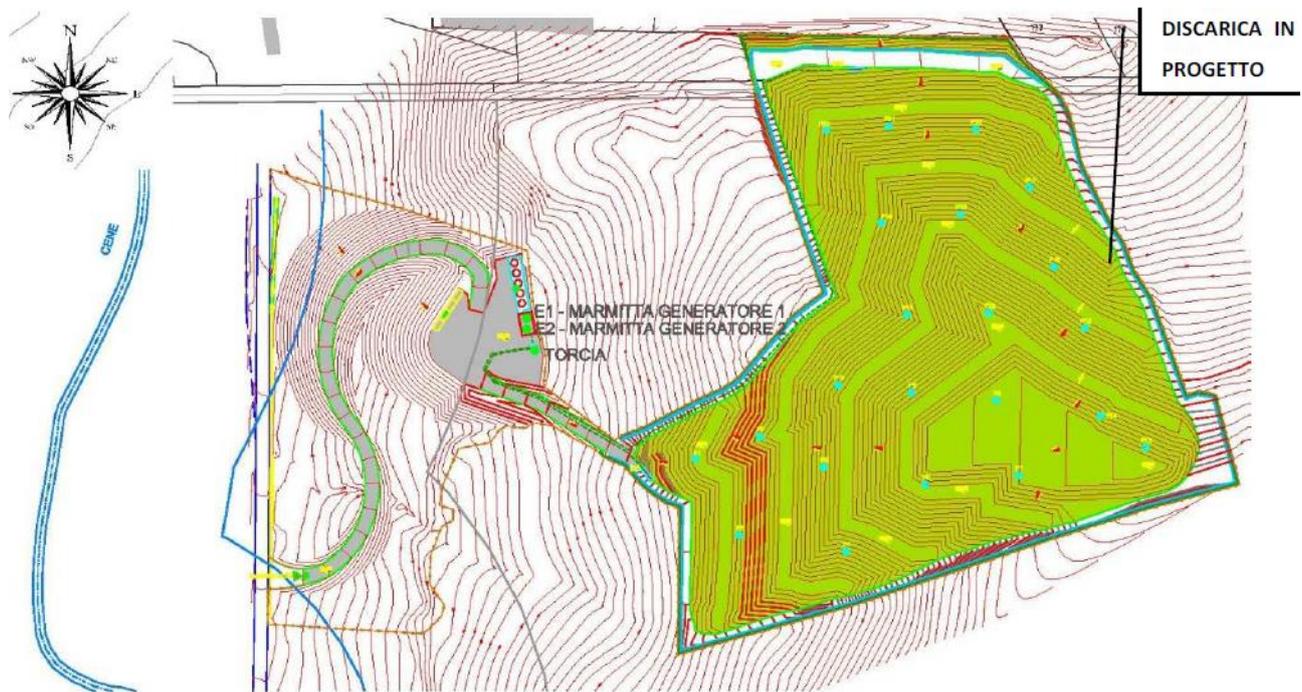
Planimetria dello stato di progetto – nuova discarica ed impianti di servizio
